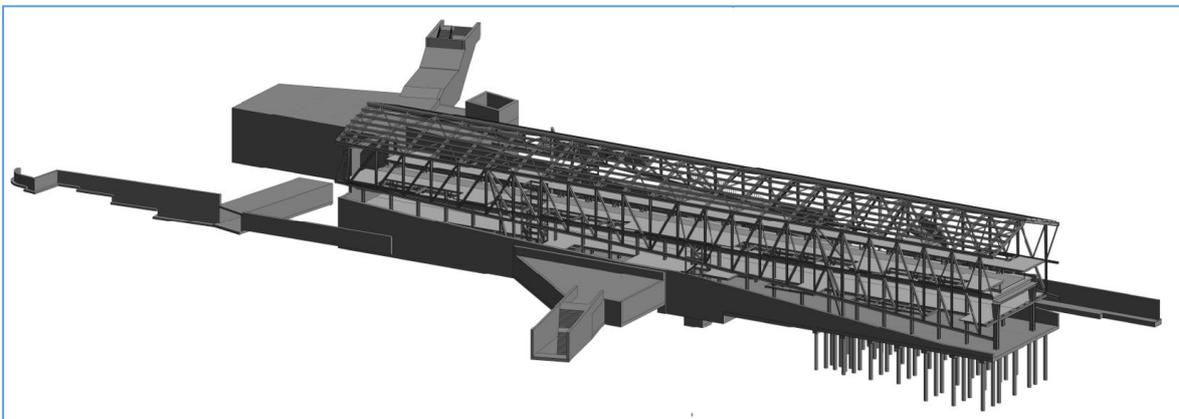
Vista 3D do modelo REVIT da estrutura da estação
